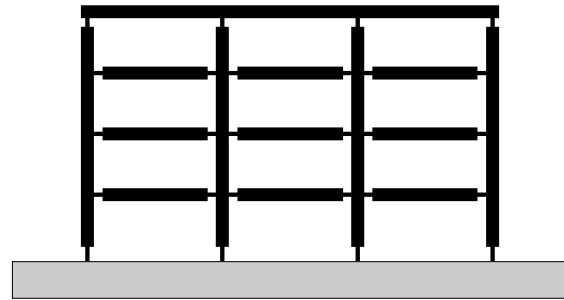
Les rotules plastiques doivent être disposées de préférence dans les poutres.
